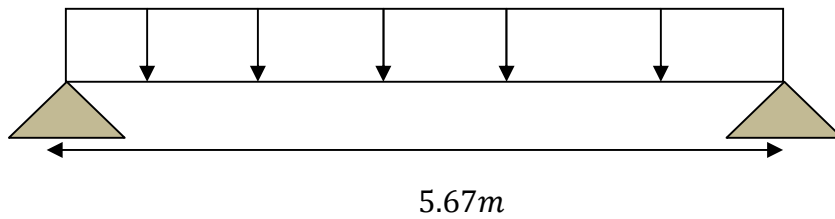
Schéma statique de la poutre brisée avec chargement
